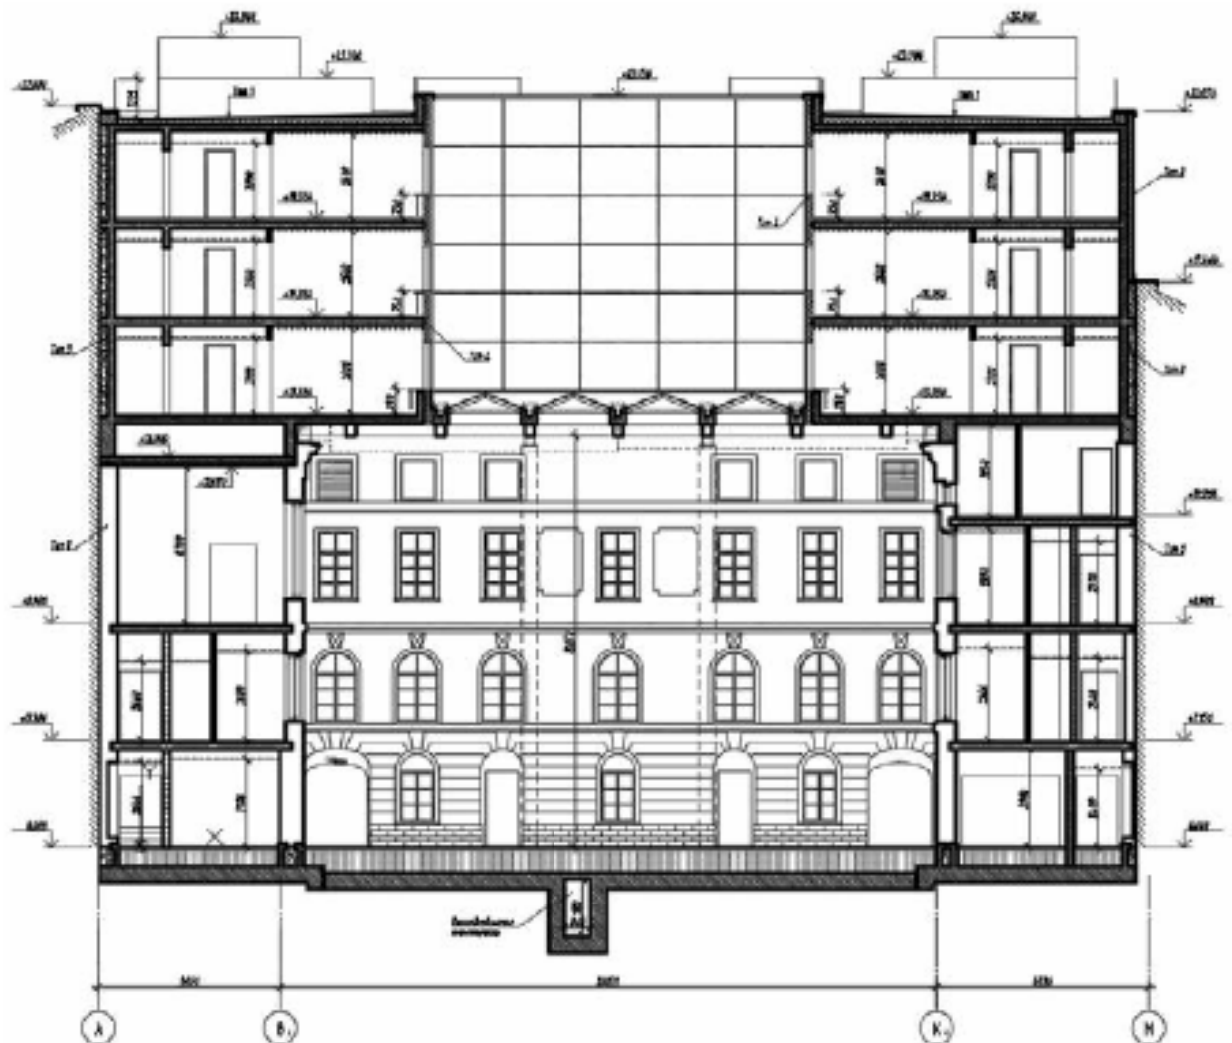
Поперечный разрез по реконструируемому зданию
